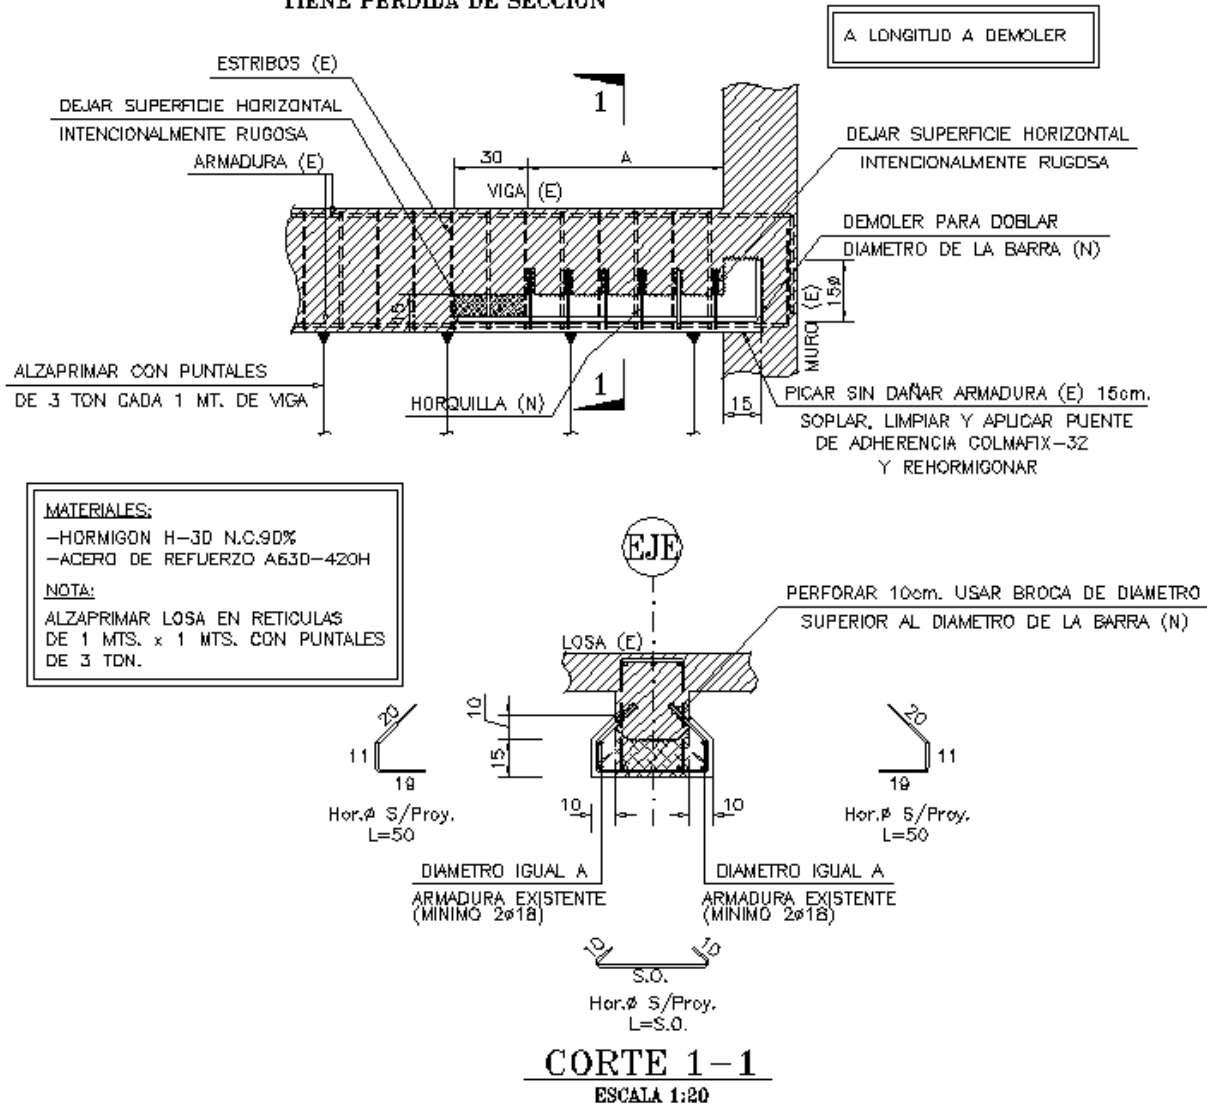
Esquema de reparación interfaz viga – muro. Piso Subterráneo – Caso A.
